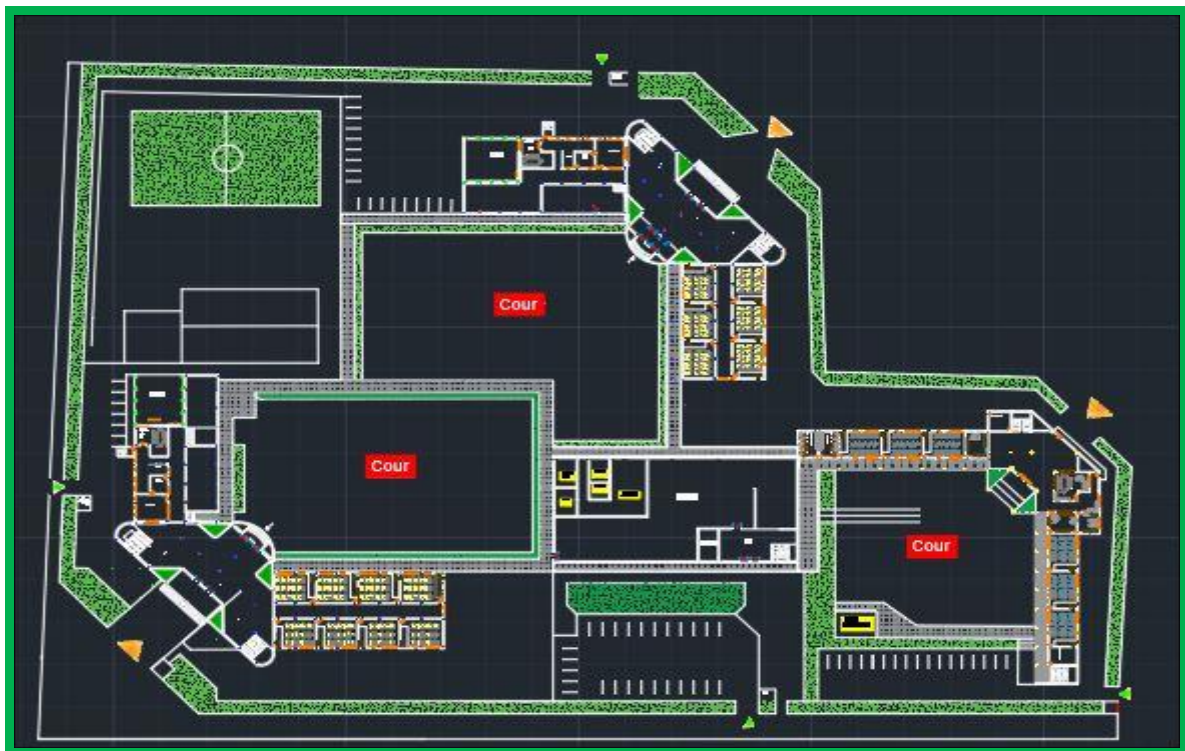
Plan d'ensemble du groupe scolaire Source (auteur2020)
